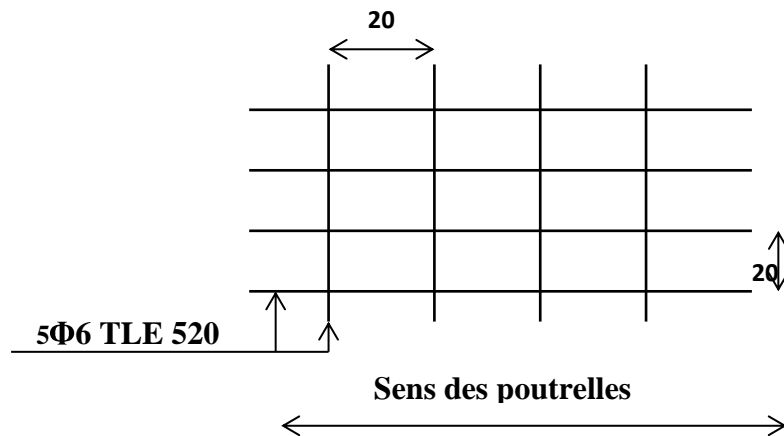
Ferrailage de la dalle de compression avec un treillis soudé (20×20) cm.
